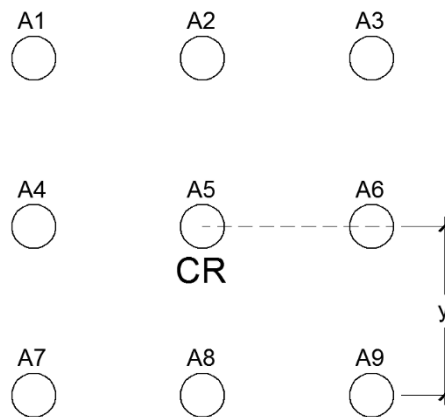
Distribución de aisladores LRB en planta
